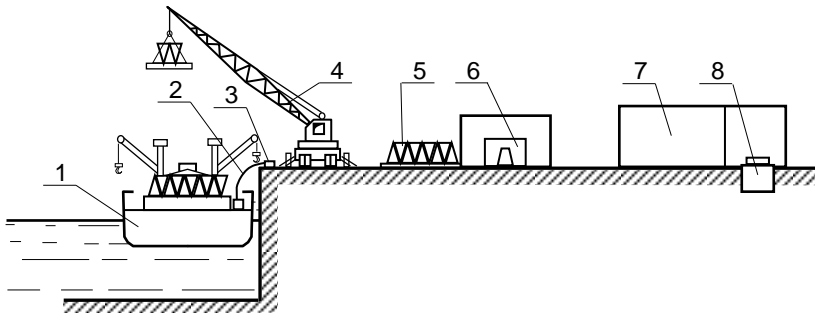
Схема причала для приема хозяйственно-бытовых стоков, фекалий и мусора:
